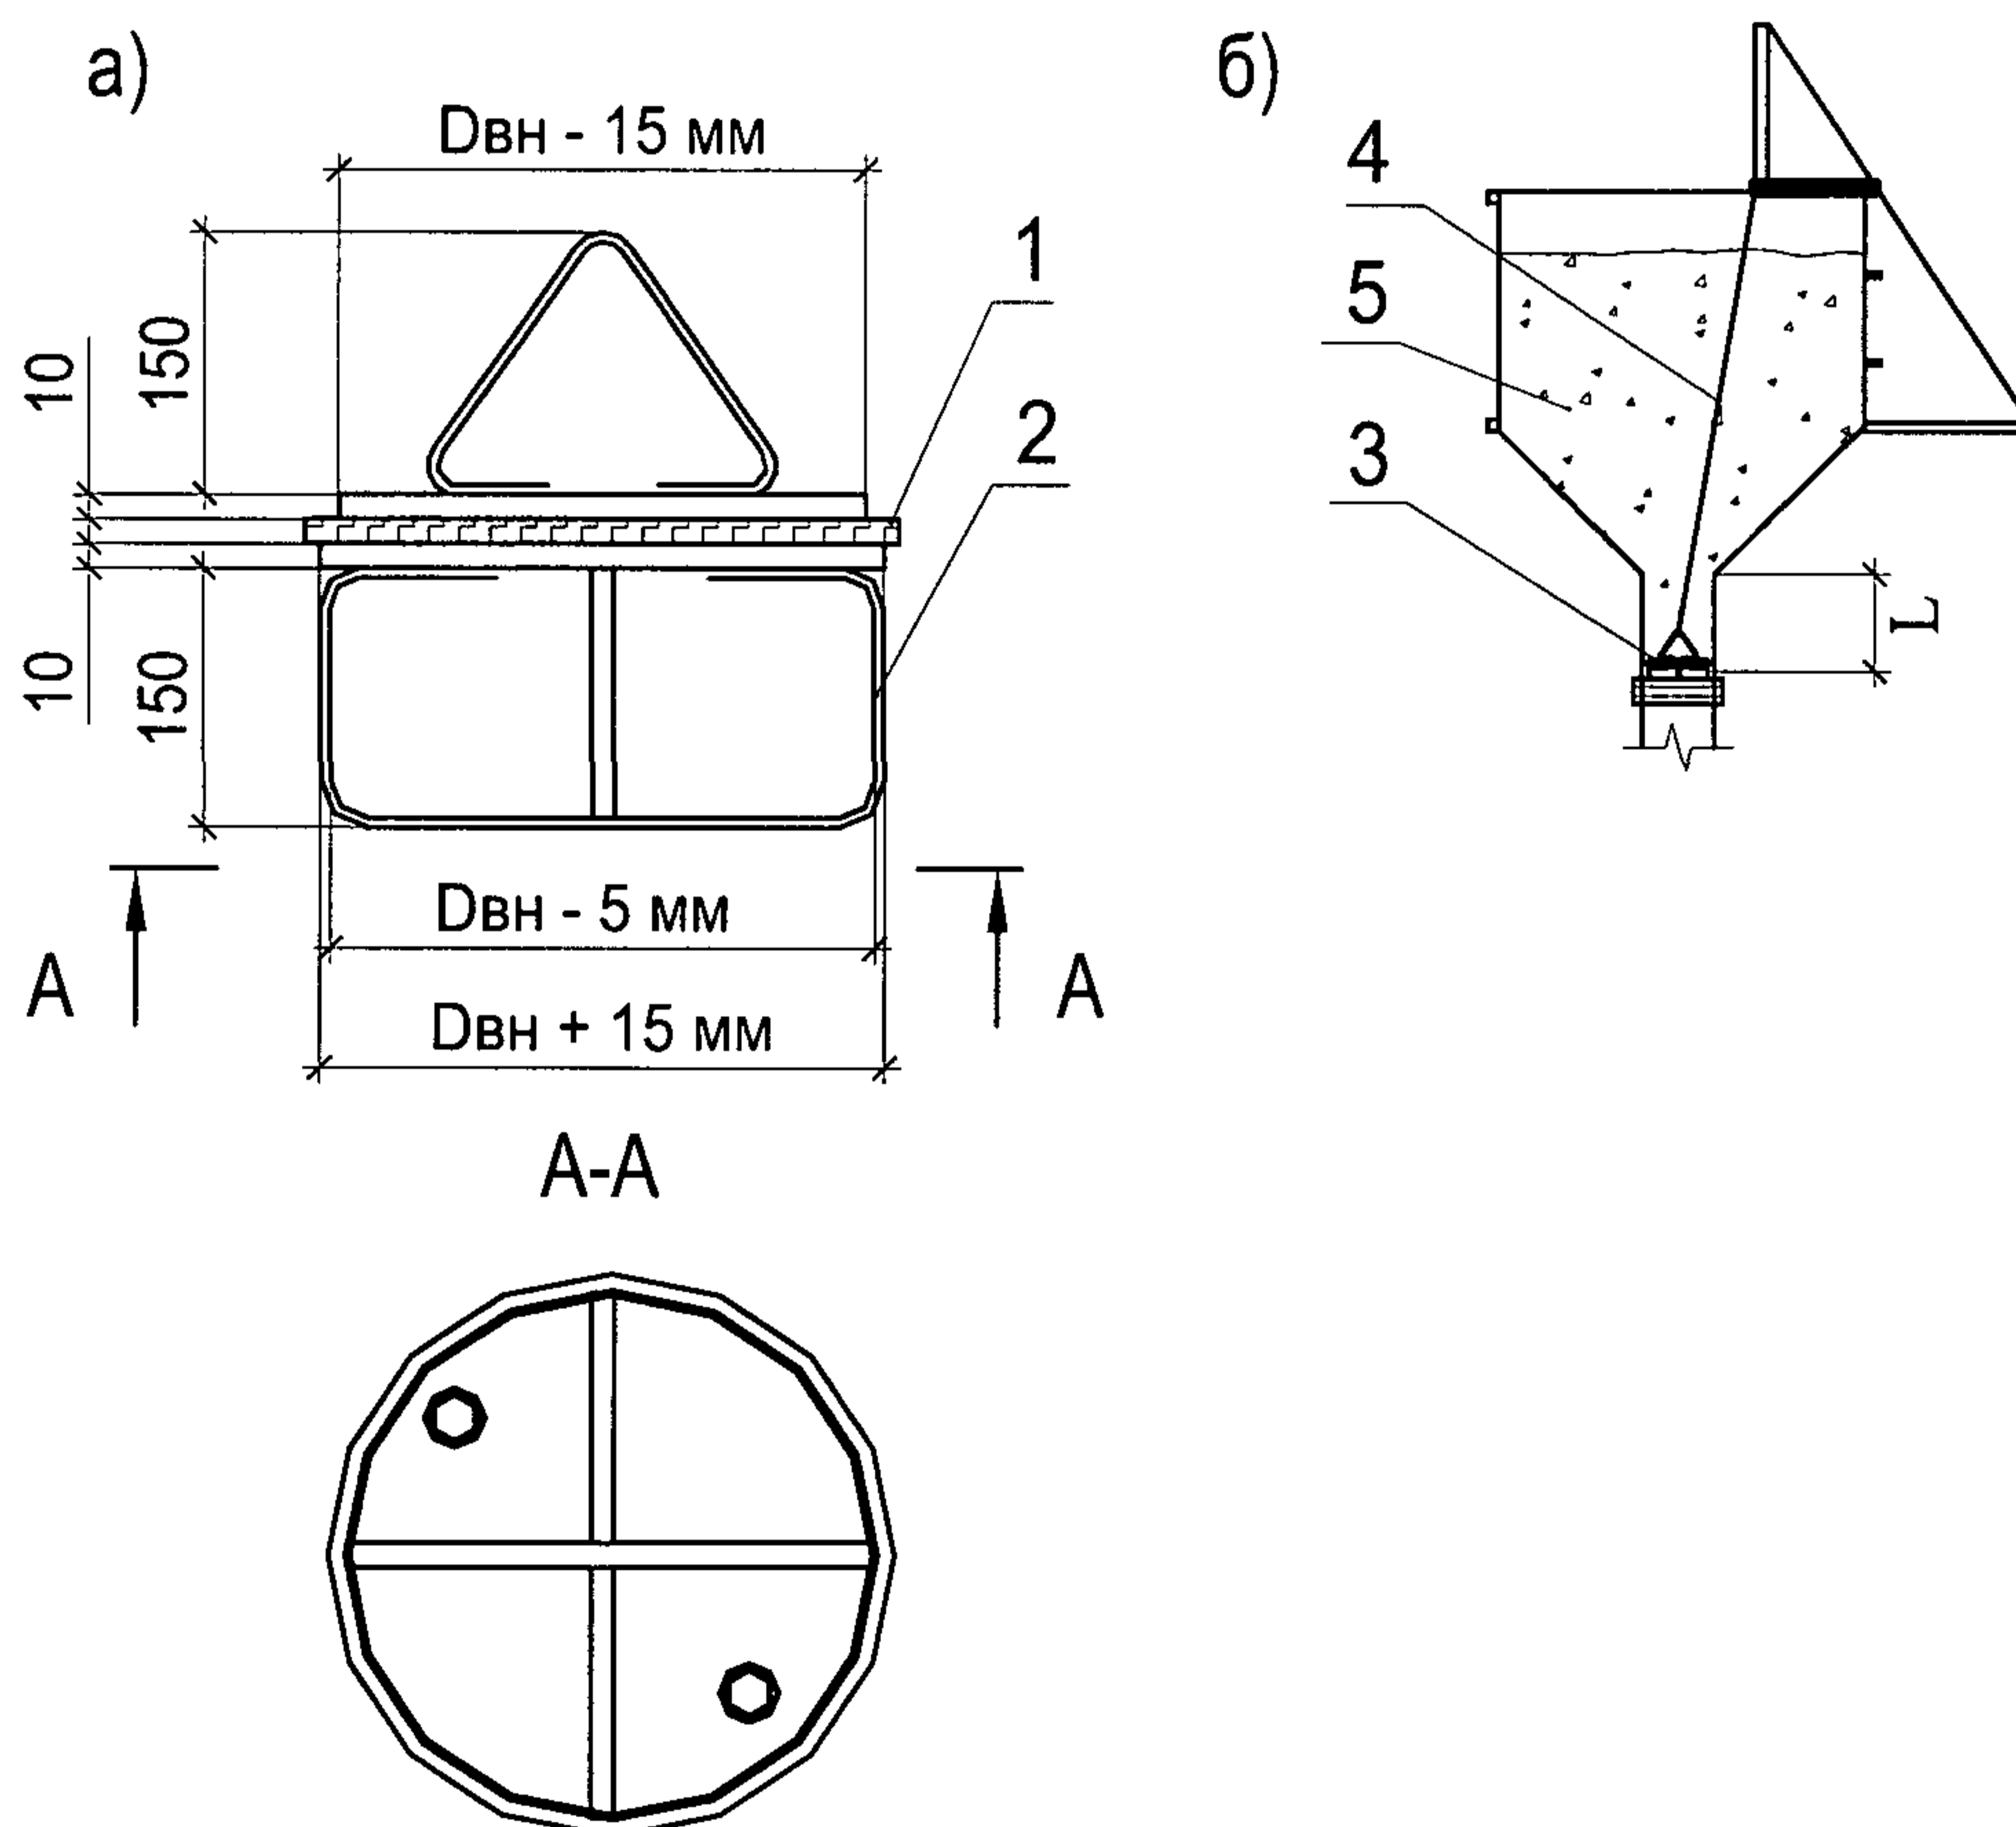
Стальная пробка, устанавливаемая в основании бункера при подводной укладке бетона
